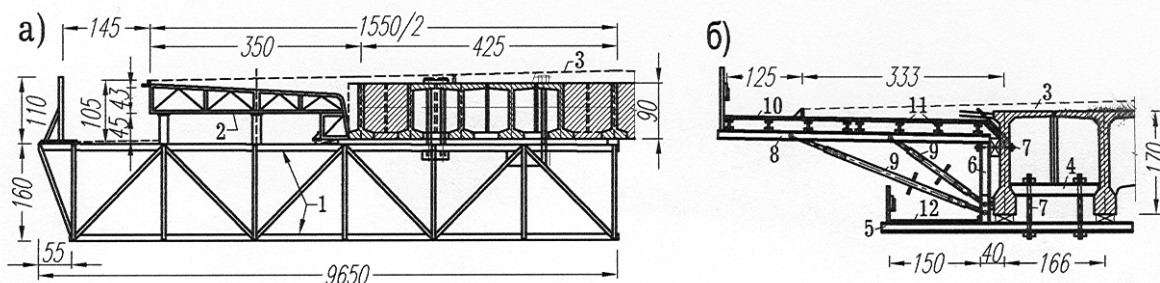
Схеми підвісної опалубки ГНДЛ-88 (а) і фірми DoKa (б) для бетонування консолей накладної плити: 1 – підвісні металеві ферми; 2 – блоки опалубки; 3 – контур накладної плити; 4 – опорні поперечини; 5, 8 – нижній і верхній ригелі; 6 – стійка; 7 – стяжні болти; 9 – шпindelьні розкоси; 10 – дерево-фанерні плити; 11 – балки Н20Р; 12 – нижній робочий настил
